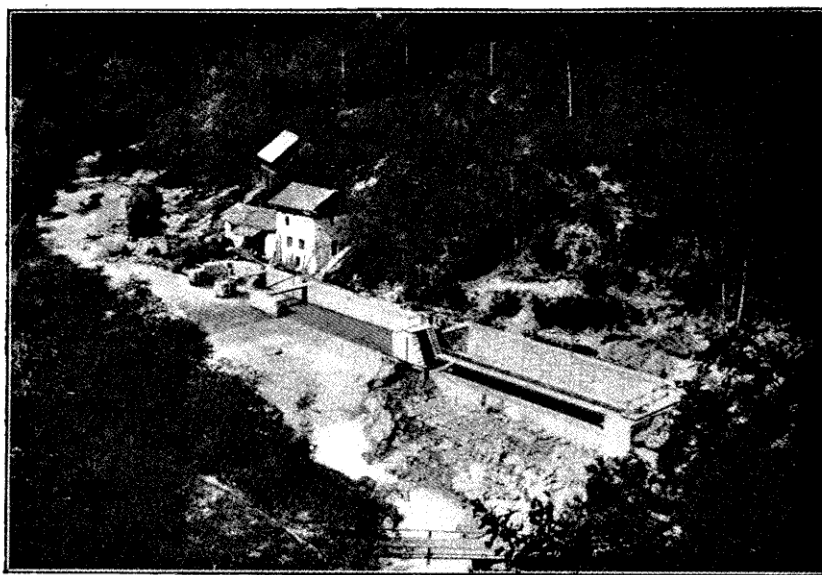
Vue d'une prise d'eau sur le torrent de Belleville.
